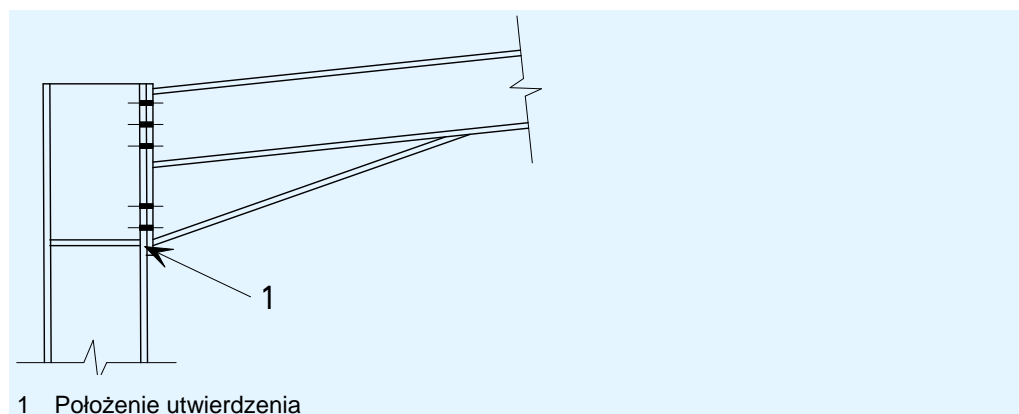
Typowe stężenie pasa wewnętrznego
